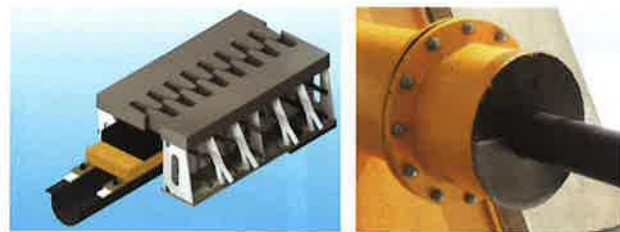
非排水型伸縮装置 写真-1 ケーブル緩衝材
